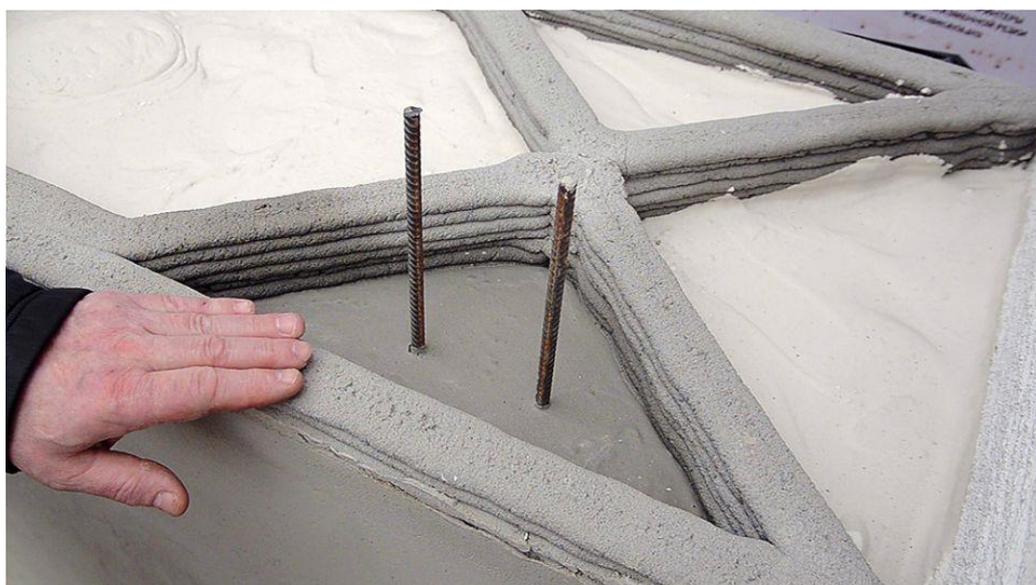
Вариант вертикального армирования и заполнения контура стен
